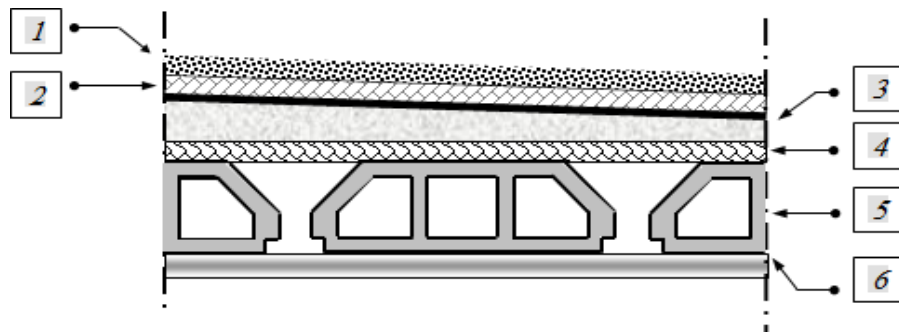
Coupe verticale du plancher terrasse à corps creux.
